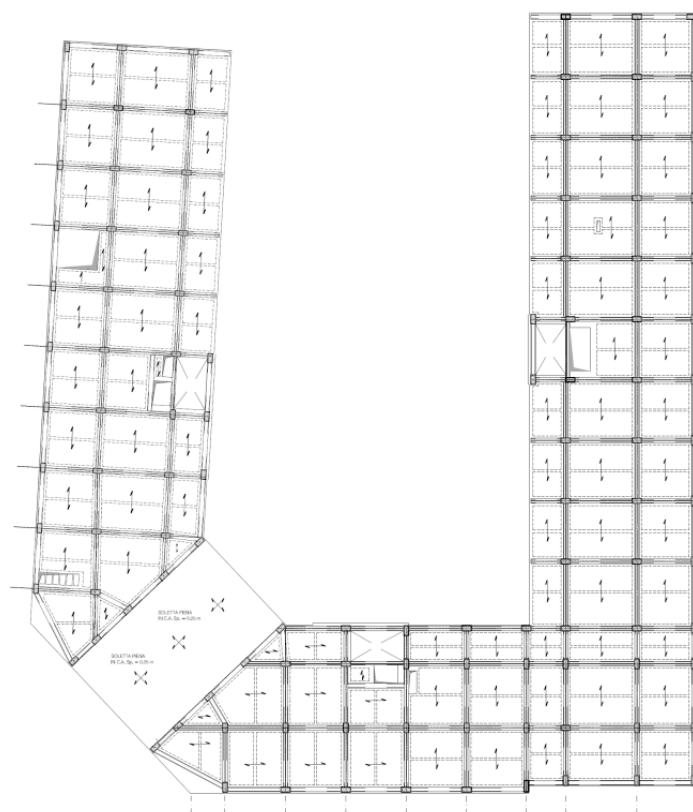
Pianta di carpenteria di un piano tipo della struttura a base fissa
